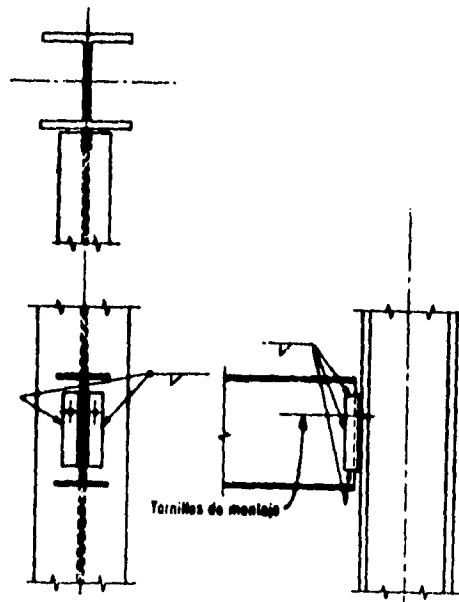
CONEXIONES SOLDADAS CON ANGULOS EN EL ALMA
